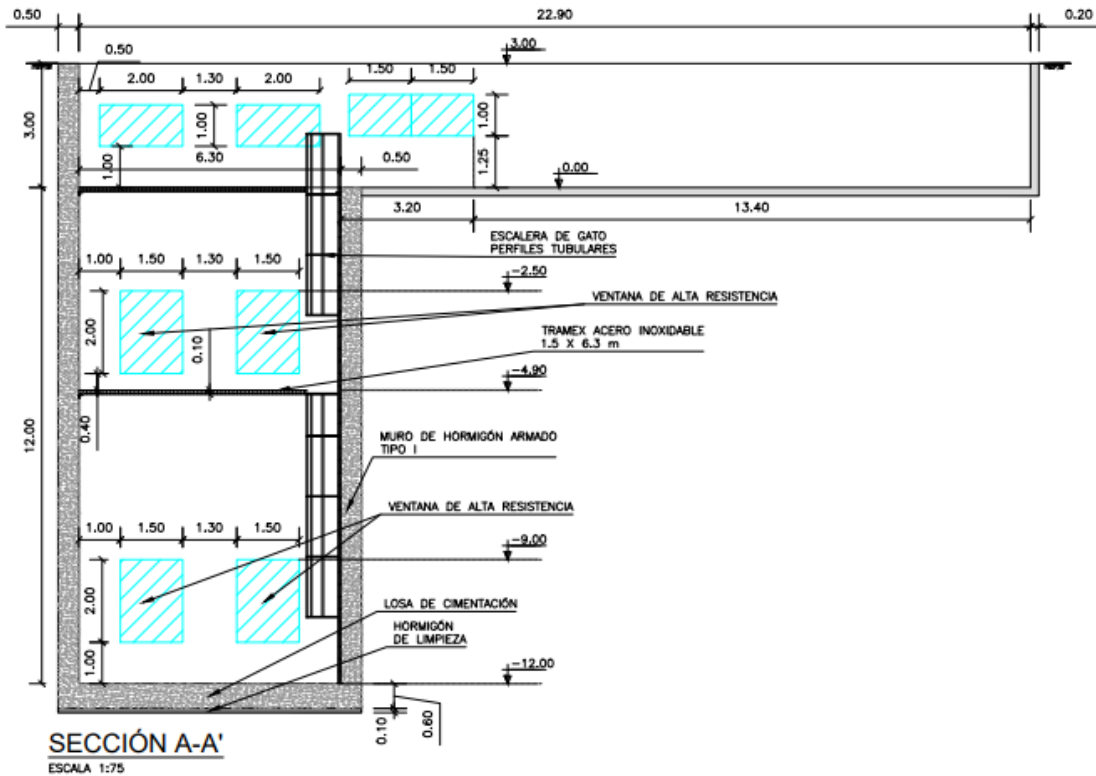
Plano de corte en perfil: galería subterránea piscina avanzada
